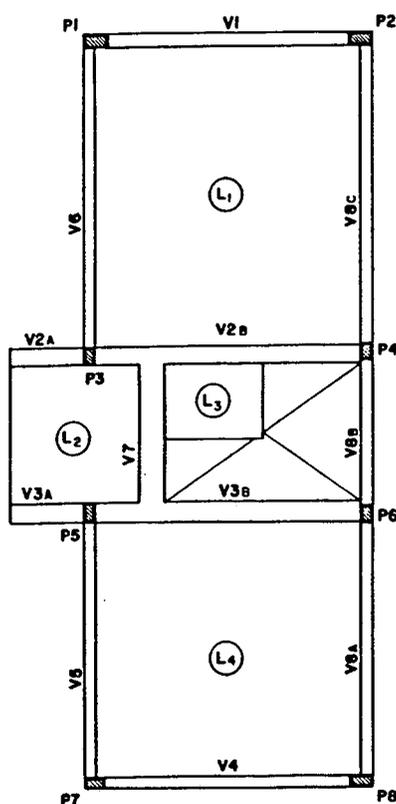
Esquema estrutural para lajes maciças e com vigotes pré-moldados - Projeto Médio
